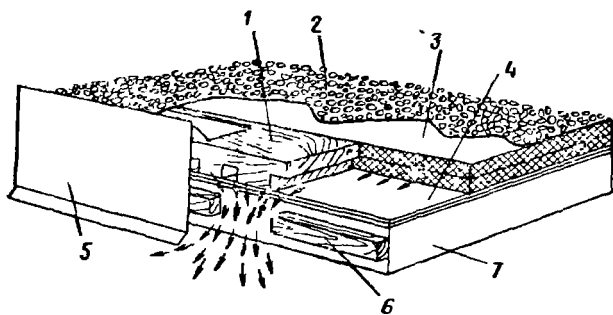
Устройство вентиляционных выходов у карнизов кровли
